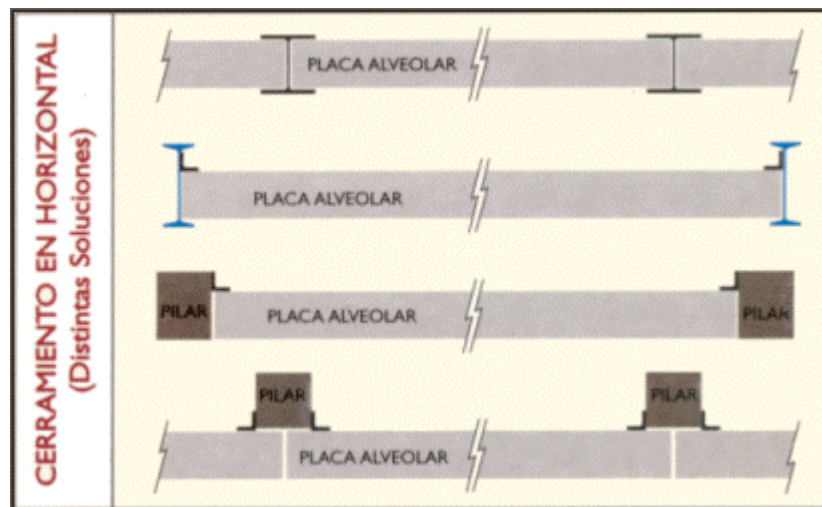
Distintas colocaciones las placas alveolares respecto a los pilares de la estructura
